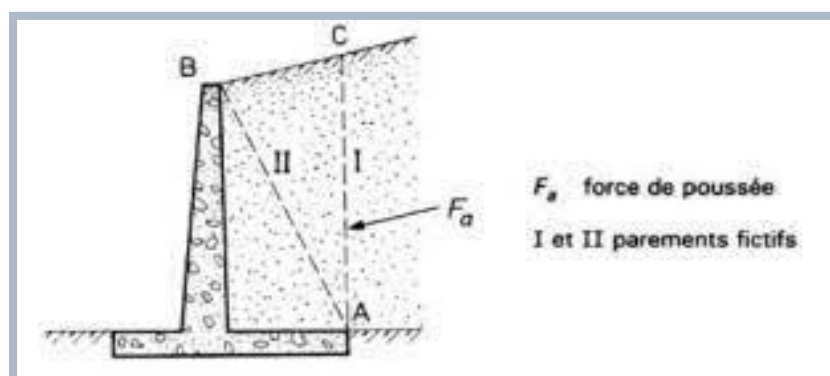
mur cantilever en béton armé. (Schlosser, C244).
